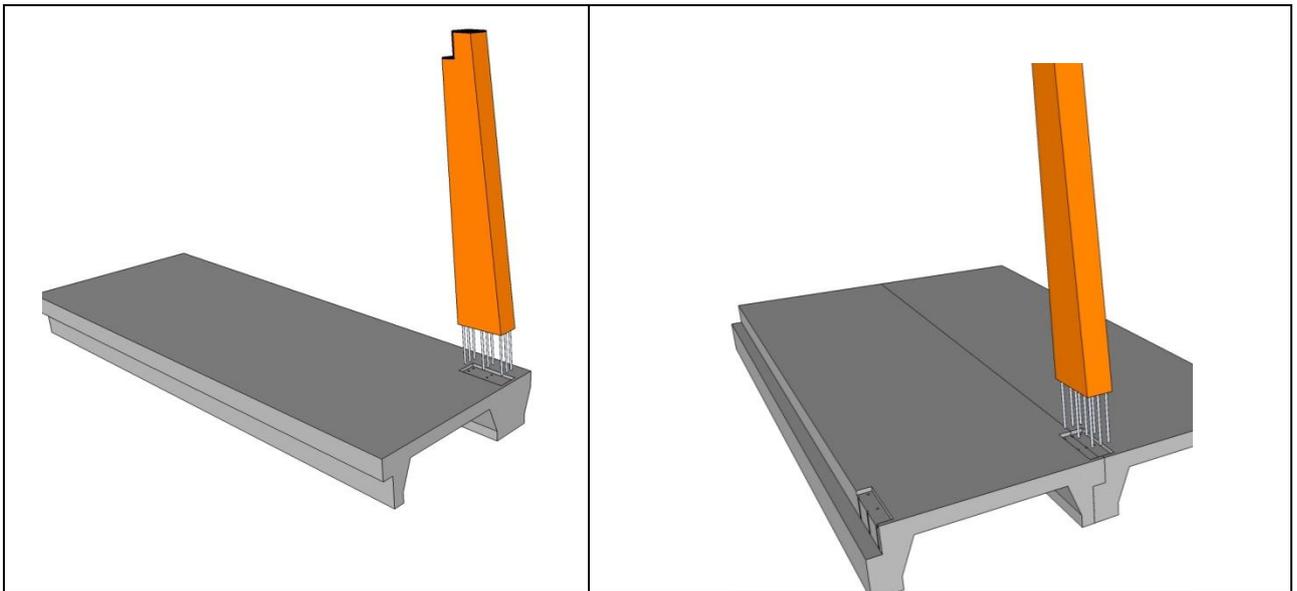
Assemblage poteau- plateforme cas de poteau rive et cas intermédiaire
